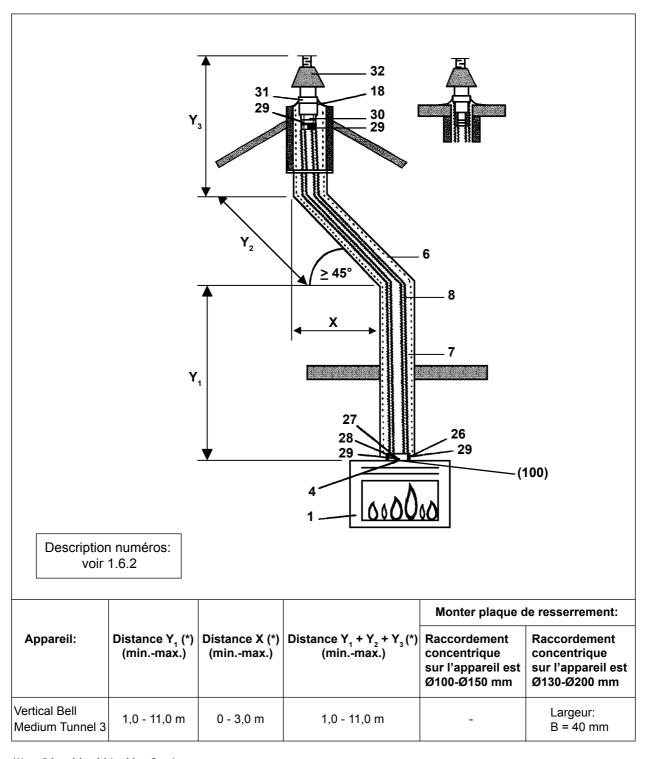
Sortie pour cheminée verticale en utilisant un conduit de fumée "fuite" existant ou si un conduit de fumée n'est pas présent (Flexible Ø100 mm / Ø150 mm)
